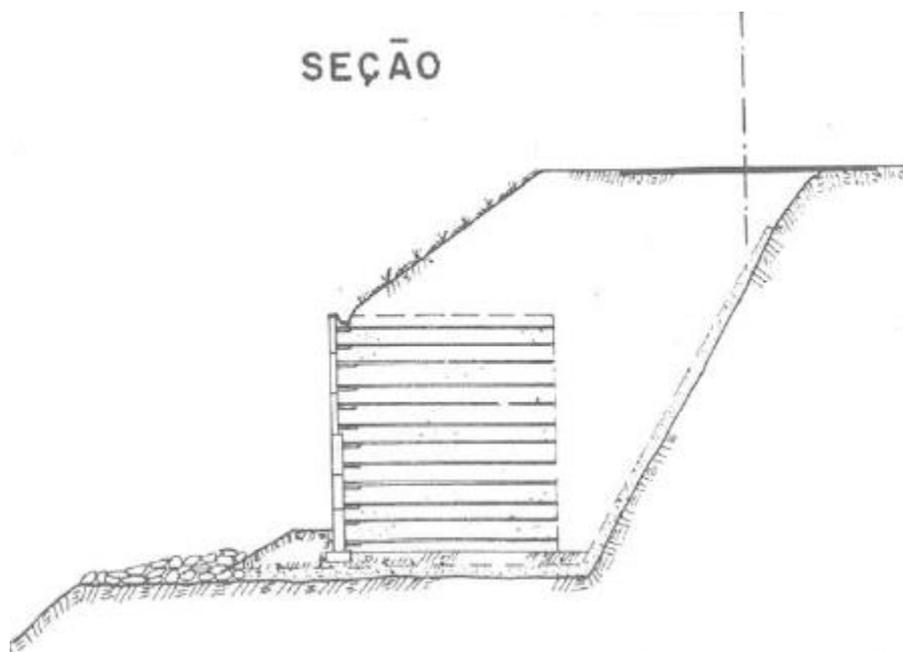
Detalhe Construtivo - "Terra Armada"
